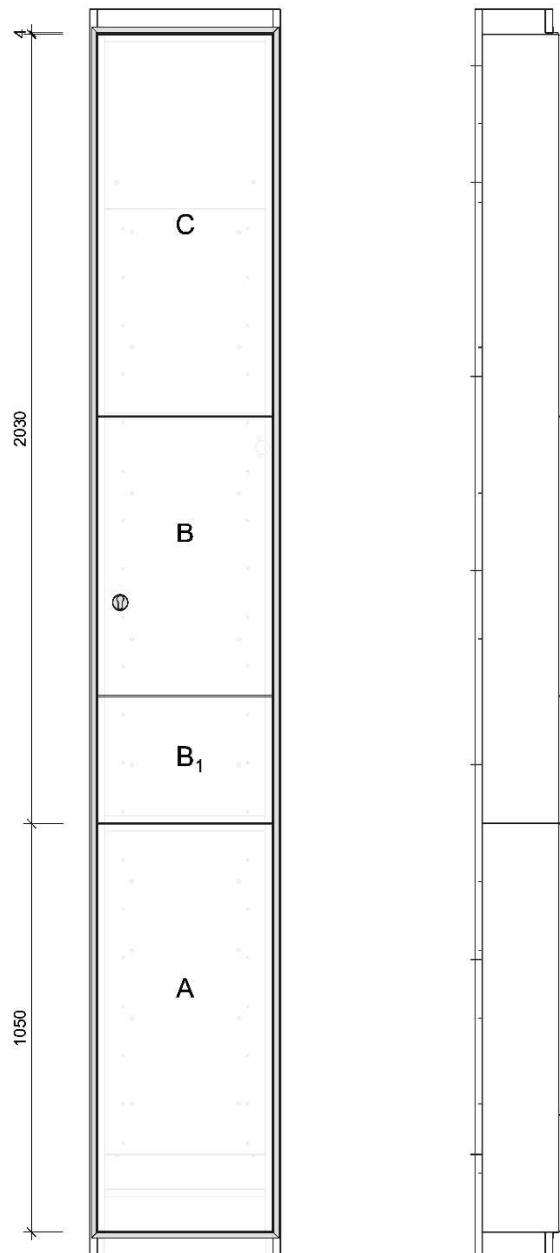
Maßzeichnung Einbaukasten, Größe L, mit Installationssäule
